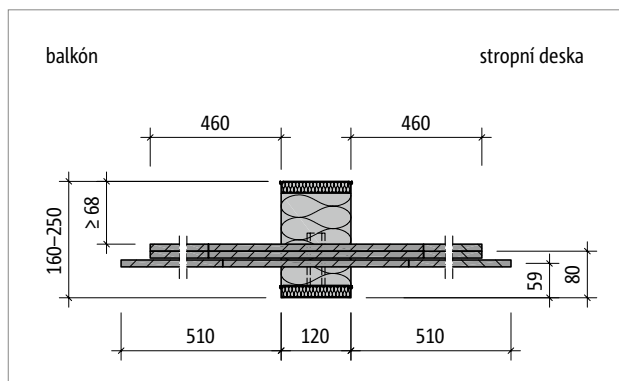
Schöck Isokorb® XT typ HP-VV1-NN1: Půdorys prvku
